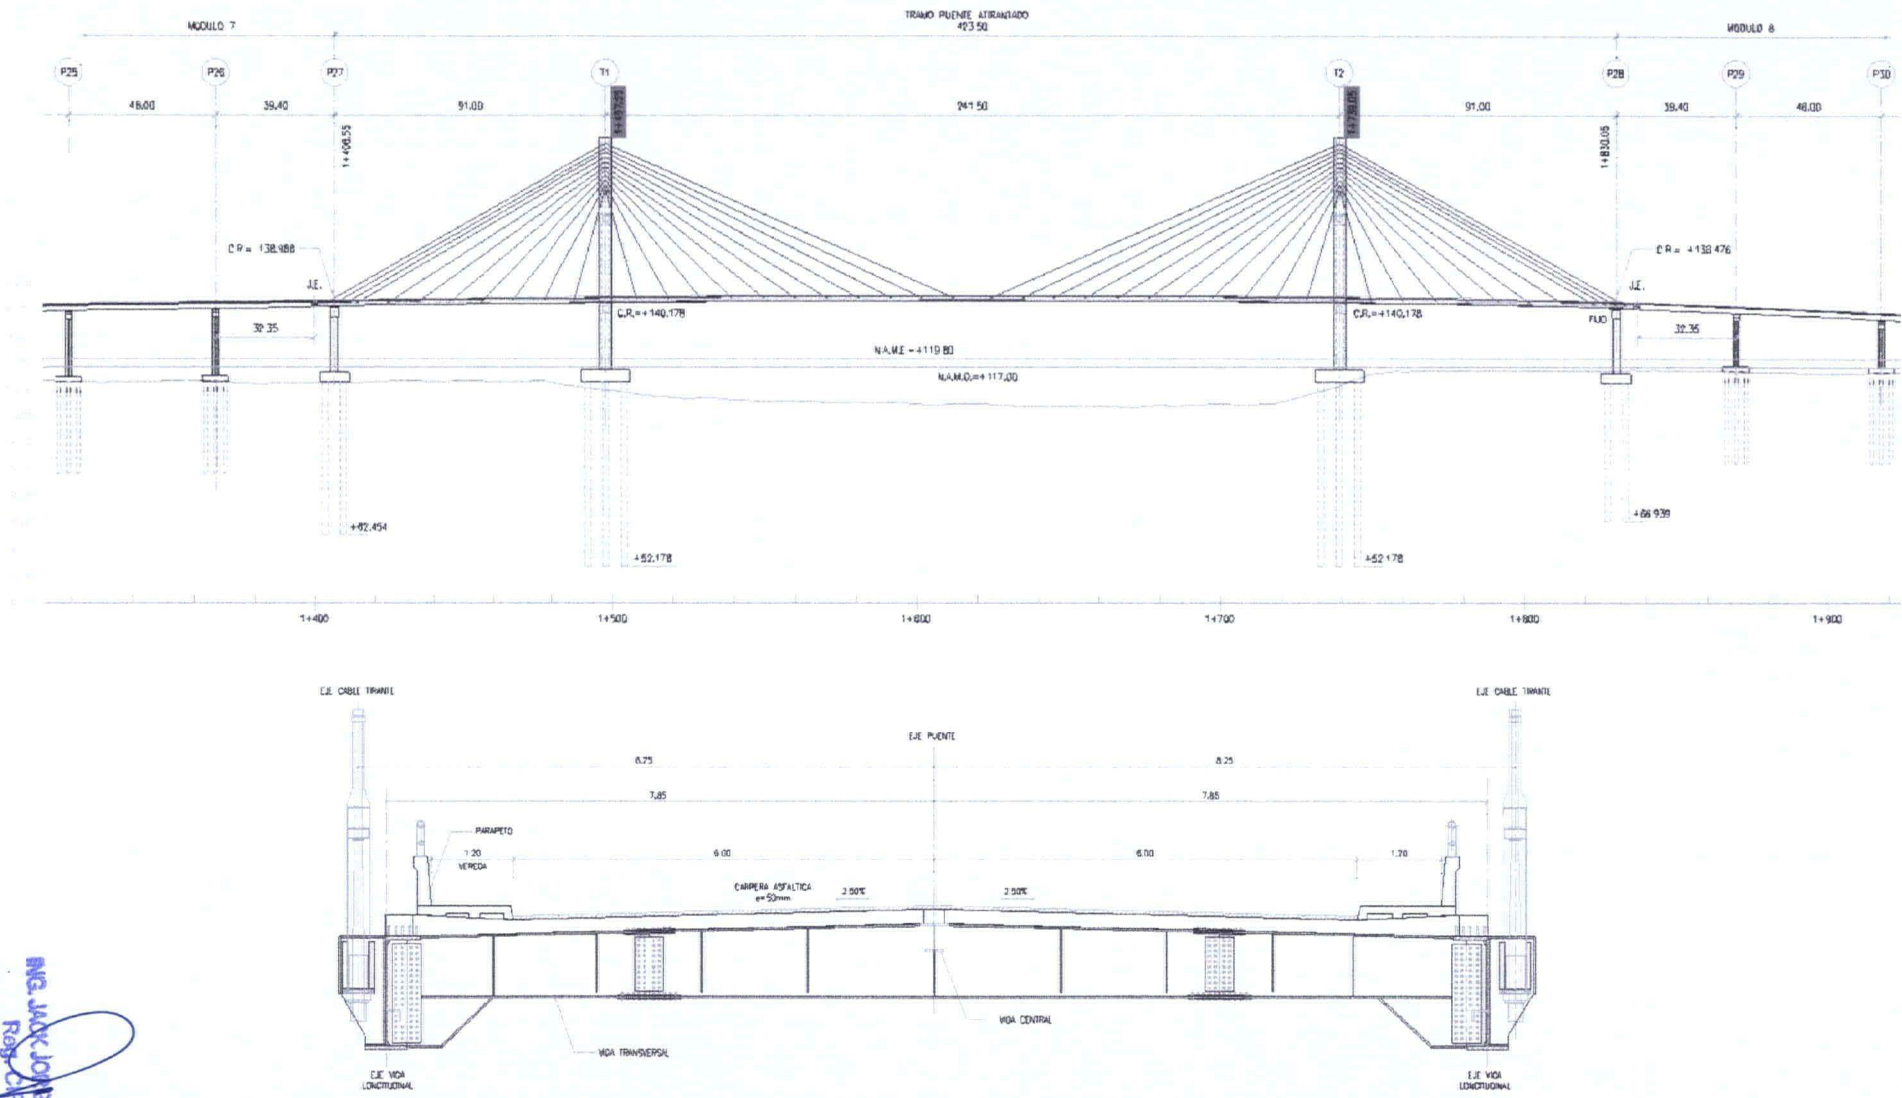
Puente NANAY, Atirantado, Elevación y sección transversal
